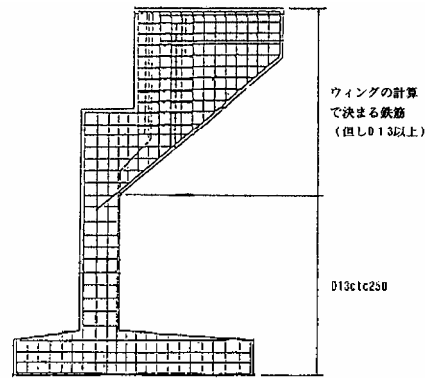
橋台側面ひび割れ防止筋（一例）
